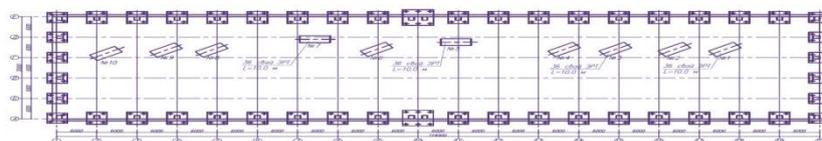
План свайного поля из буринъекционных свай ЭРТ усиления оснований фундаментов каркаса и кузнечных молотов №№1,3,5,7.
